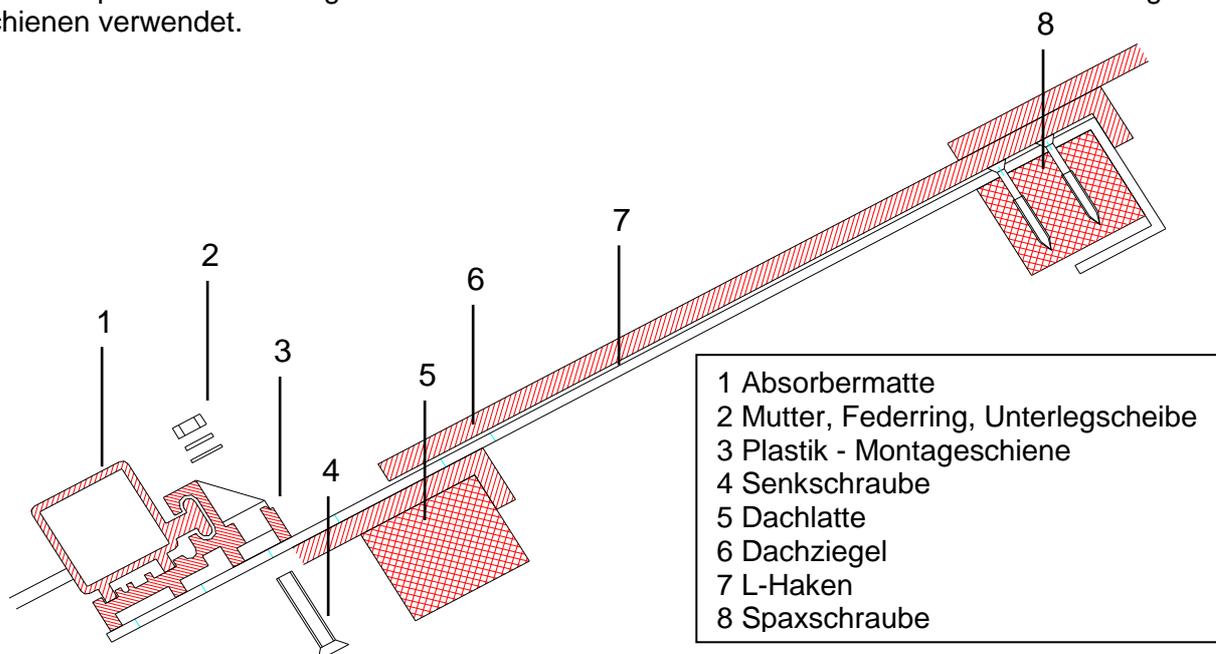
Befestigung des Absorbers auf einem Schrägdach
